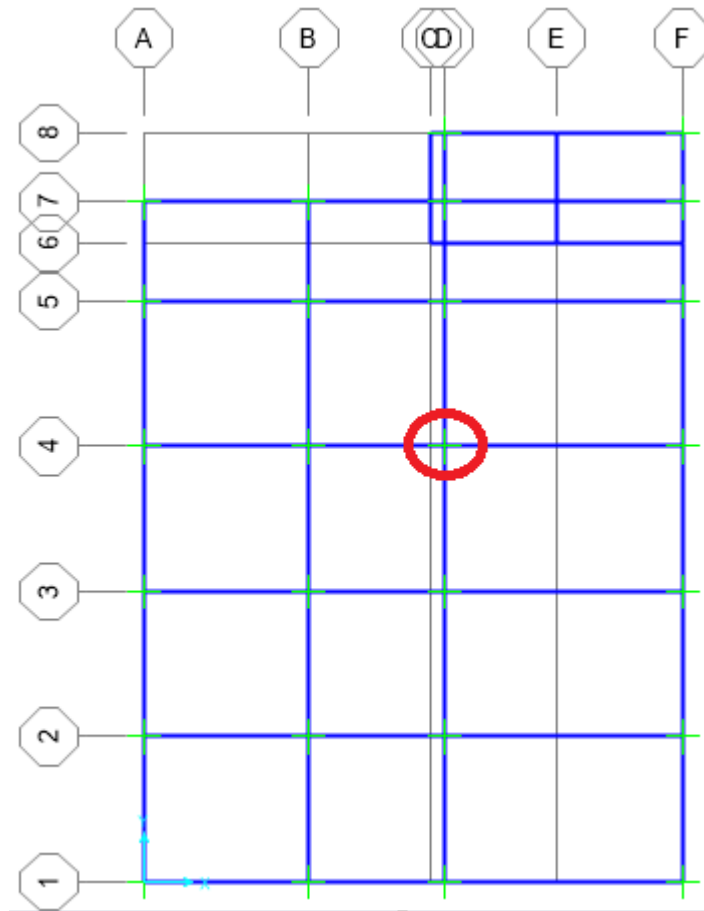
Denah *Final Kolom* di Bangunan C.2
